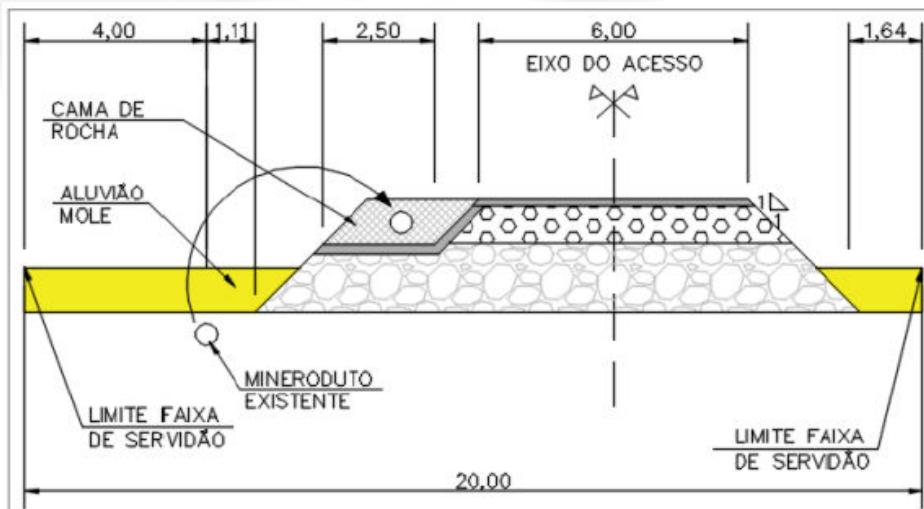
Perfil esquemático da obra. (Fonte: EIA).
